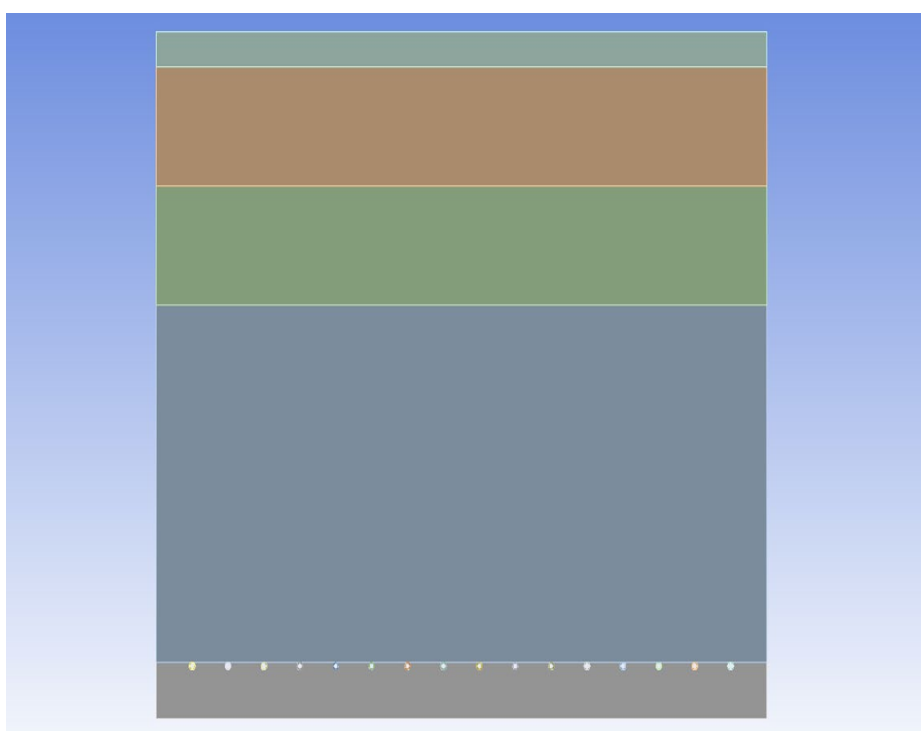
Разрез межэтажного перекрытия при укладке капиллярных труб с шагом 20 мм
